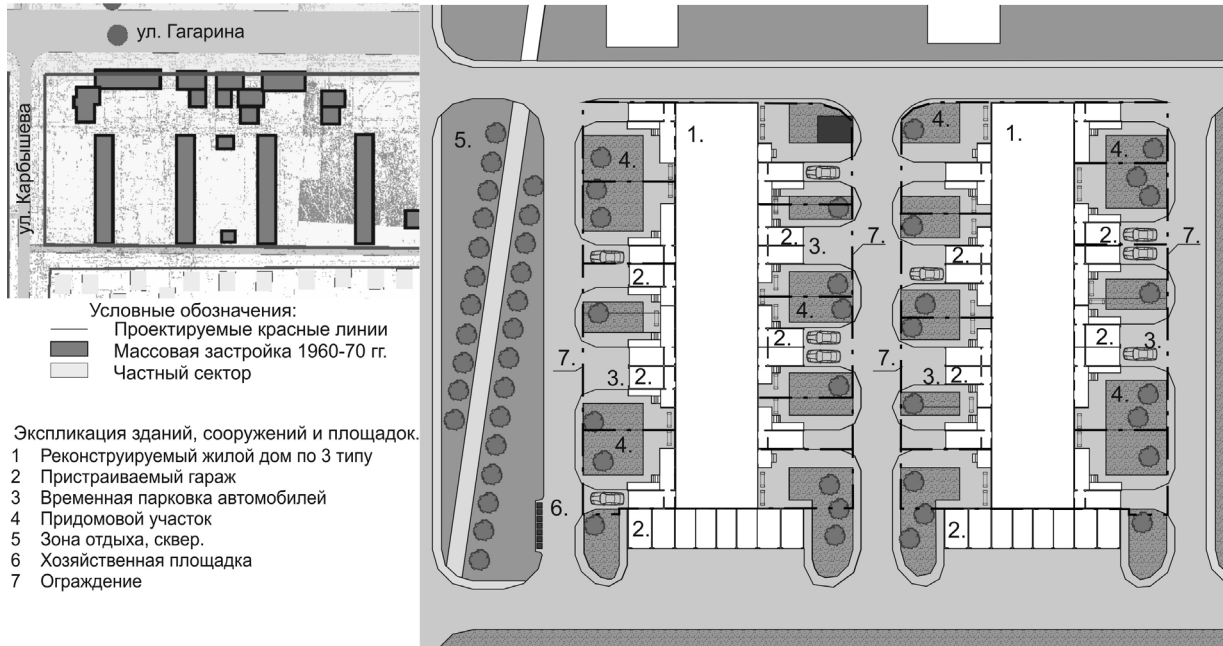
Реконструкция жилой застройки индустриального строительства 1960-1970 гг.
